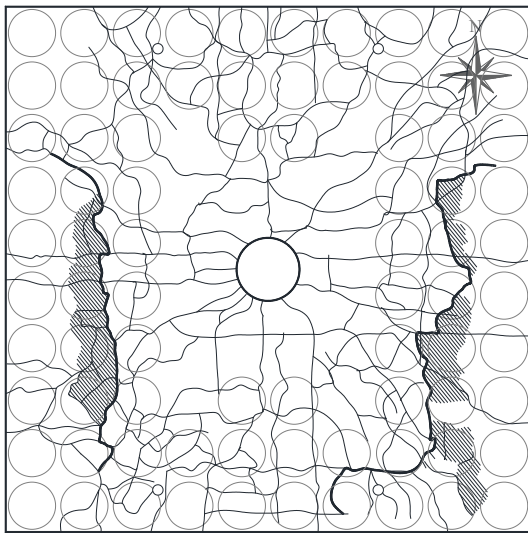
Mapa de fissuração da laje BD1
